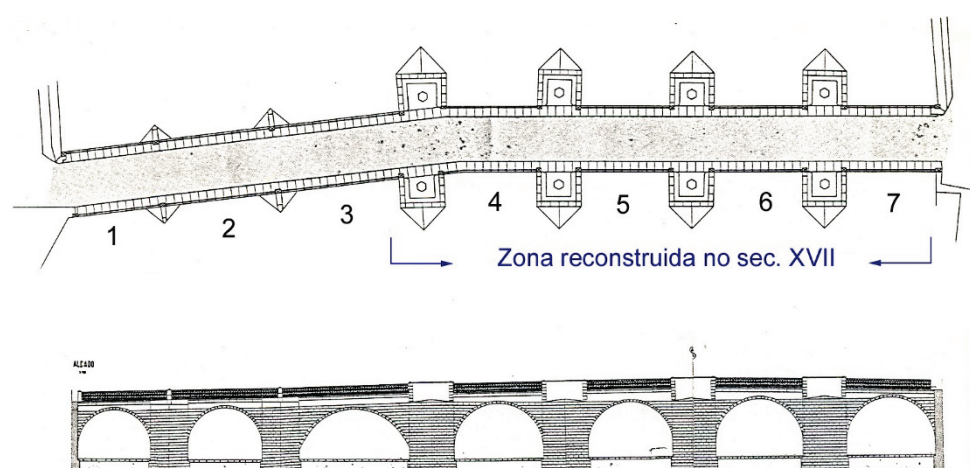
Vista geral da Ponte de Tavira. Planta e Alçado
